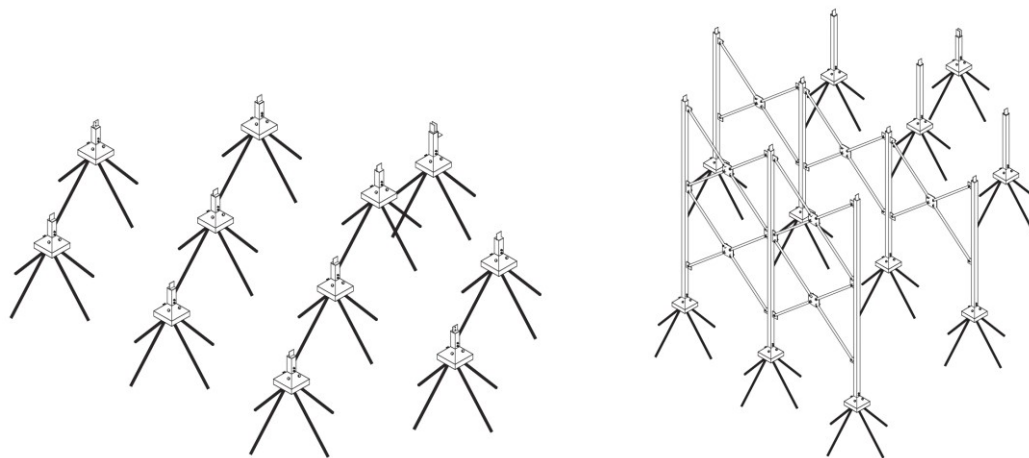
Tipo de cimentación para terreno plano y para pendiente de 40%, respectivamente<sup>218</sup>
